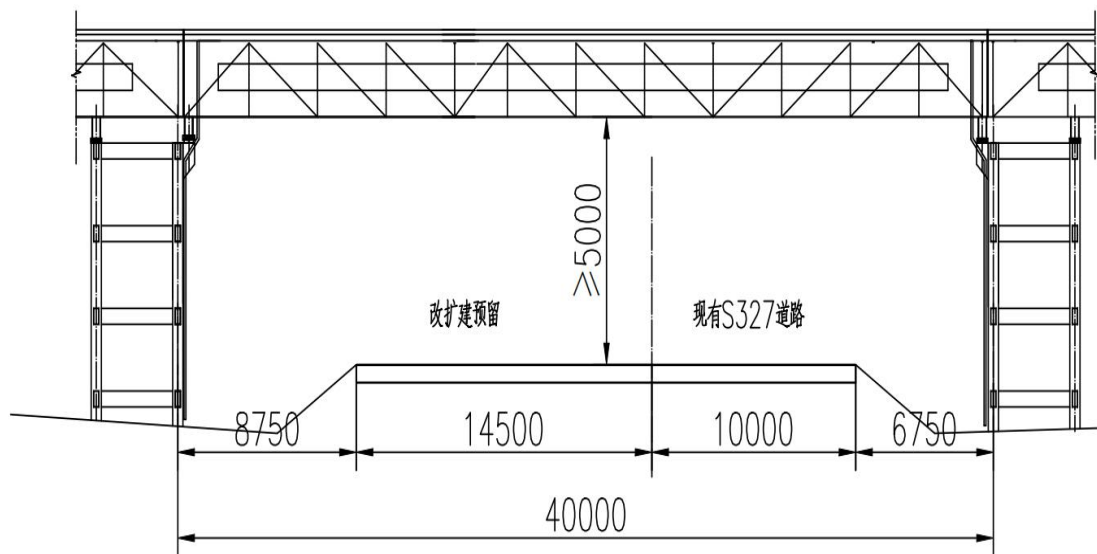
输煤栈桥与 S327 公路交叉处立面图
